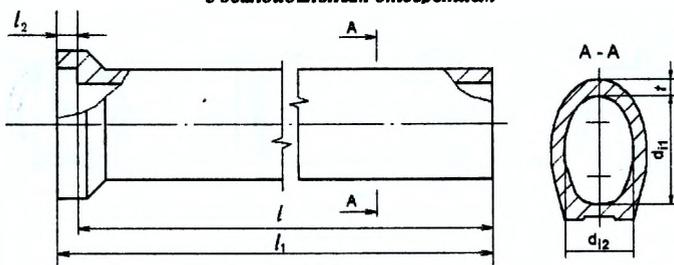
Общий вид труб типа БТЭ – бетонных раструбных с эллиптическим отверстием
